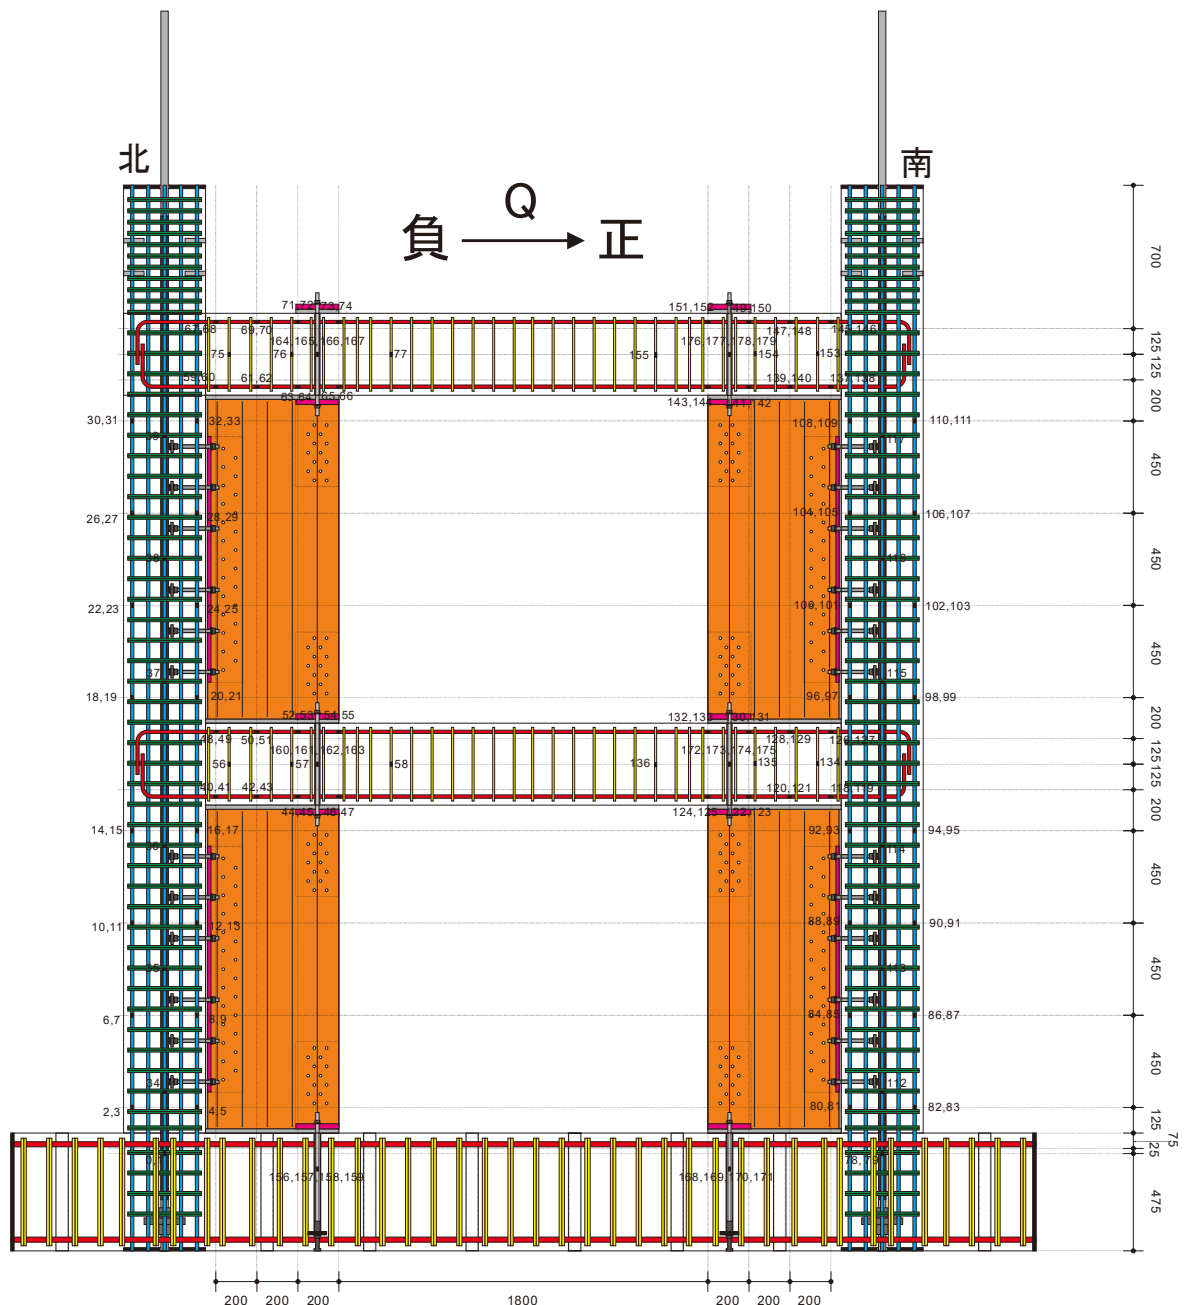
試験体 A の柱主筋、帯筋、アンカーボルトに貼付したひずみゲージの位置 (単位 : mm)
